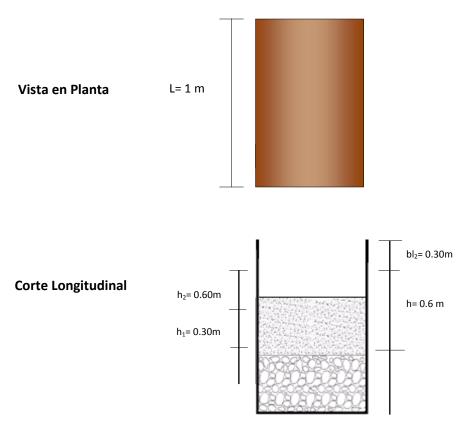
Vista en planta y sección longitudinal. Lecho de secado de lodos
